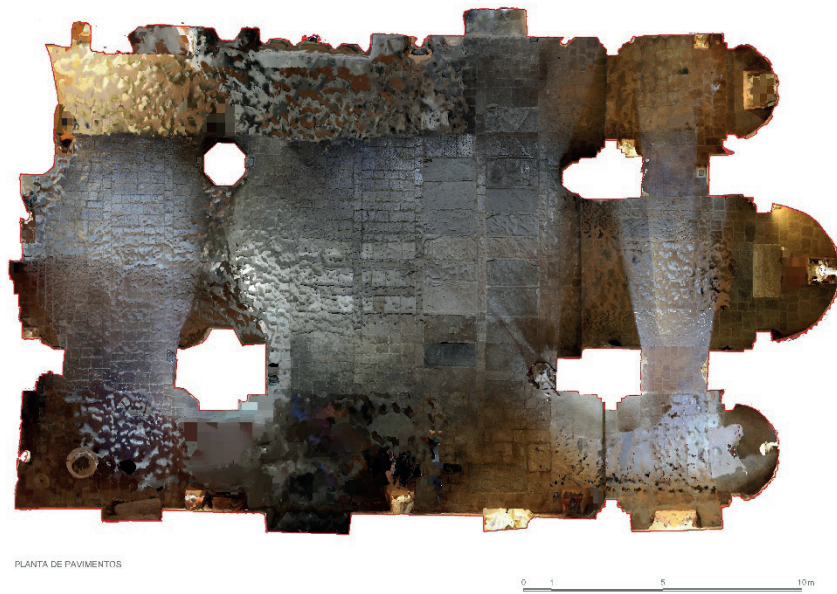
Planta de pavimentos generada a partir del modelo de fotogrametría
